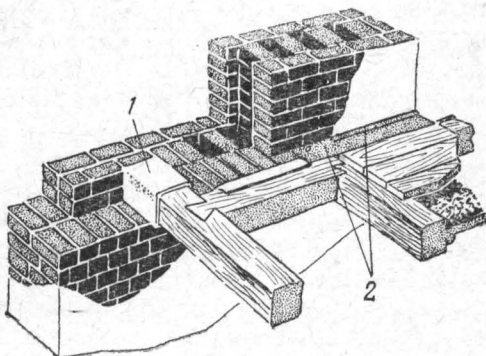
Устройство ригеля при встрече балок перекрытия с дымоходами
